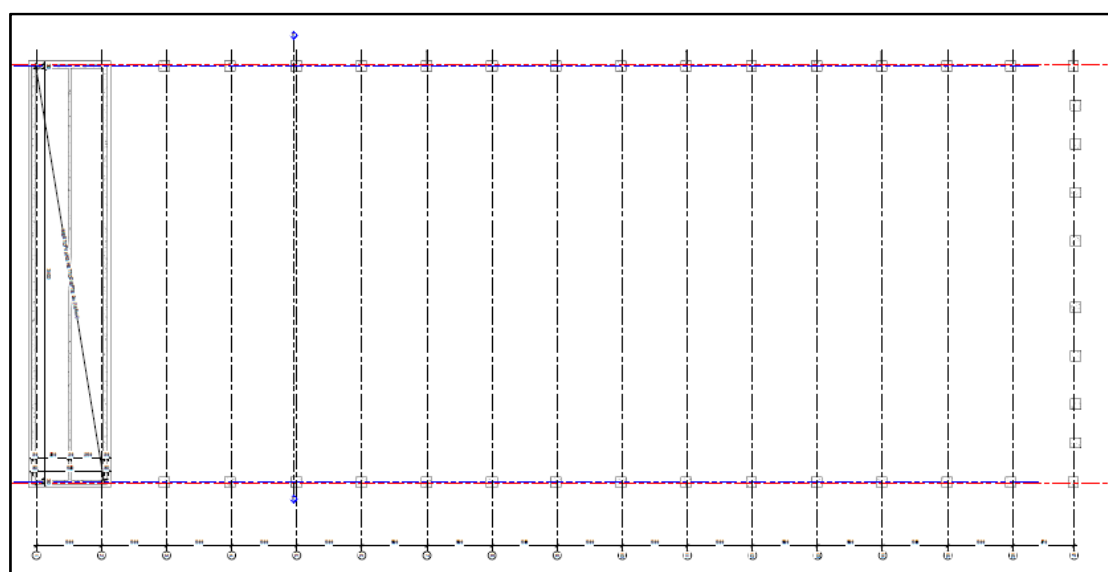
Funderingsplan nieuwbouw jongveestal¹⁴
